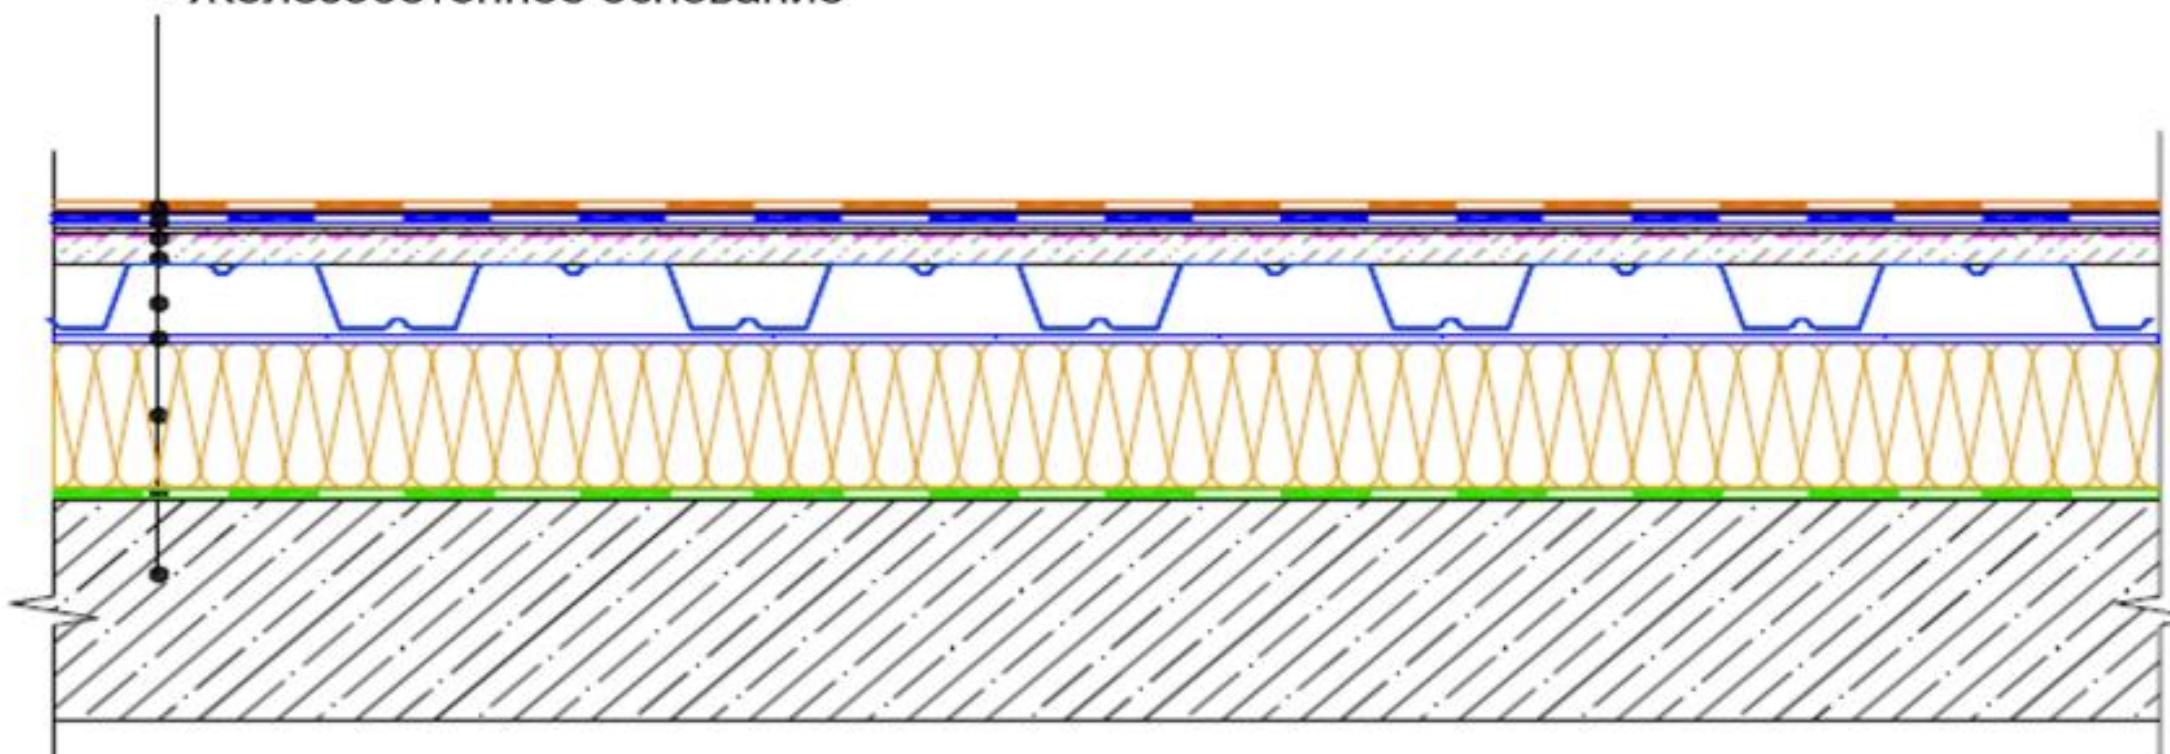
Разрез системы совмещенной вентилируемой крыши
